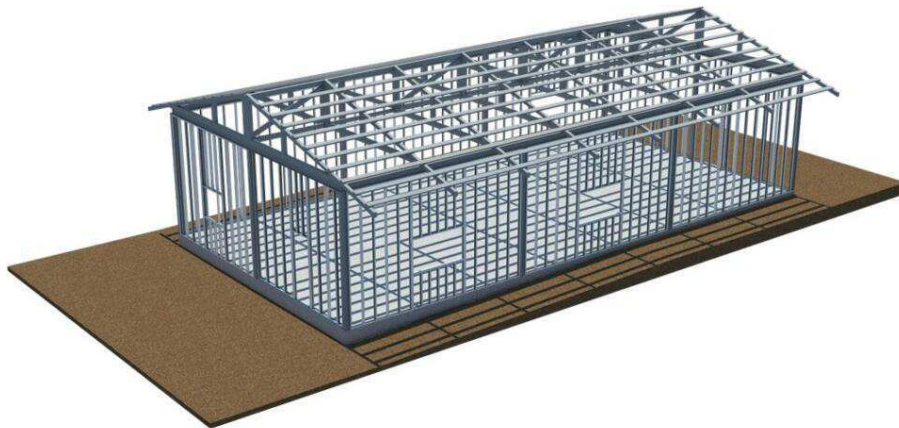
Montagem da cobertura. Fonte: construindocasas.cm.br 2022.
